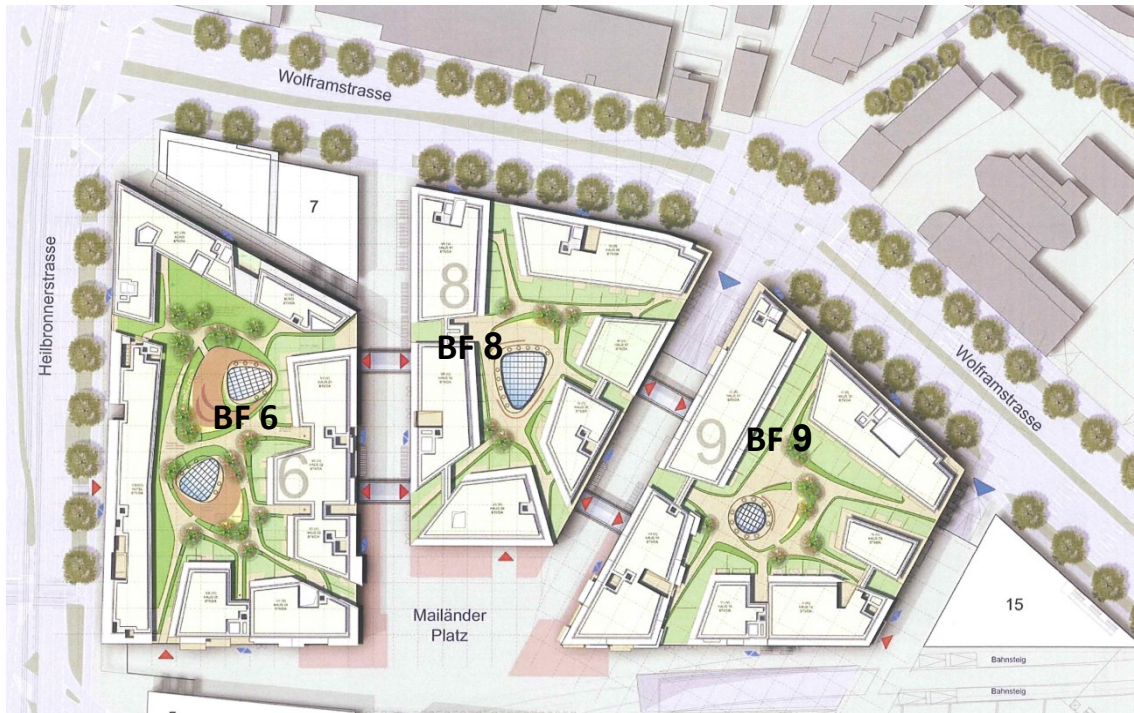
Lageplan des Gebäudekomplexes mit Kennzeichnung der Baufelder
